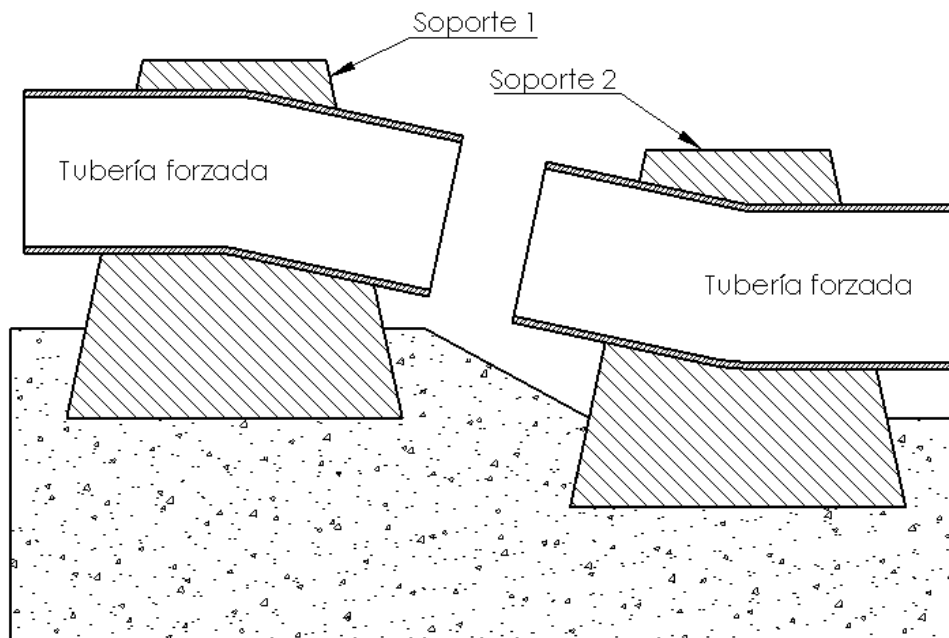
Representación constructiva de soportes diseñados para tubería. [18]
